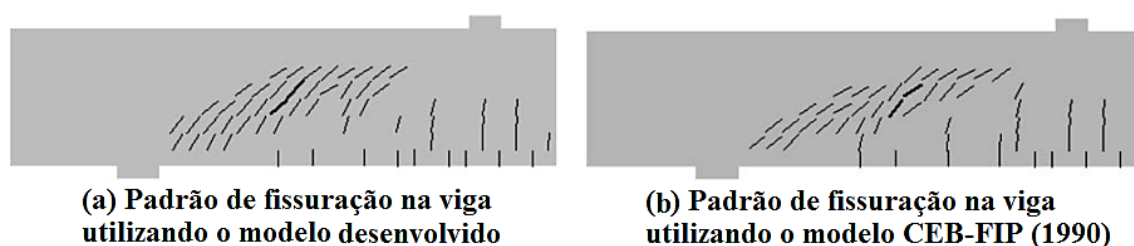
Simulação numérica de um ensaio de viga - Jendele & Cervenka (2006).
